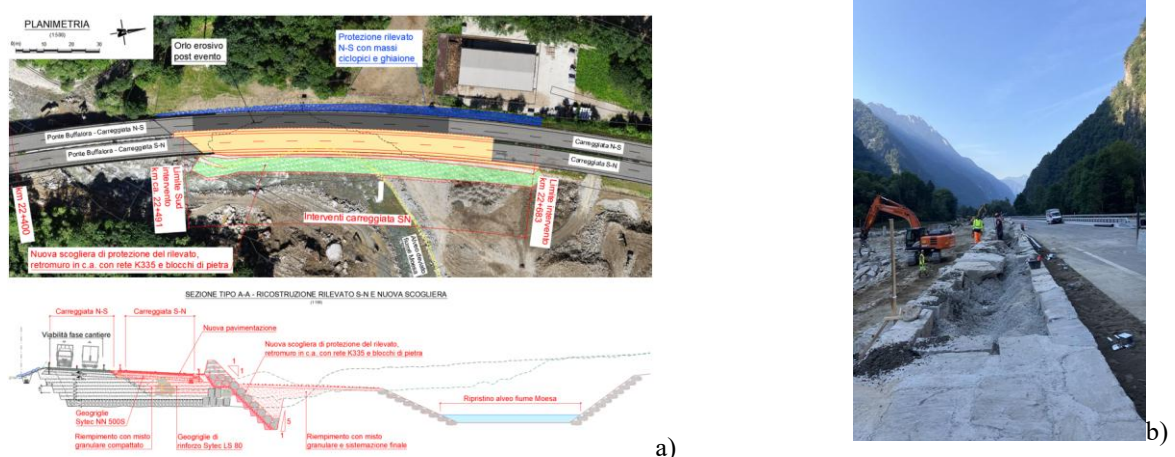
a) Foto aerea e sezione di progetto carreggiata SN; b) posa scogliera di protezione carreggiata SN.
